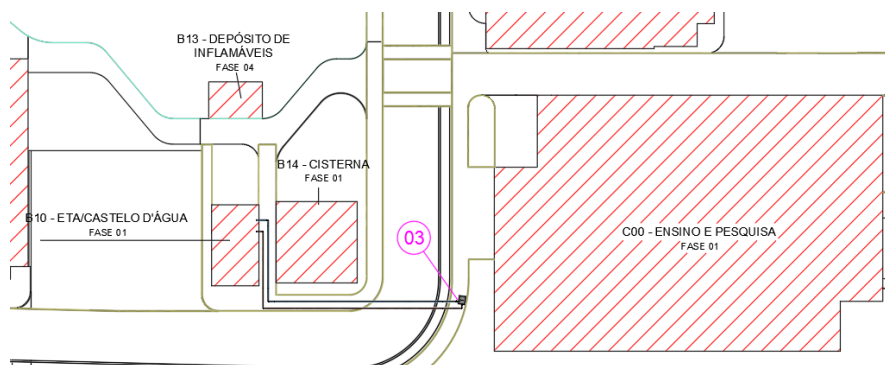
Planta trecho (Castelo d'água / Bloco C00)
